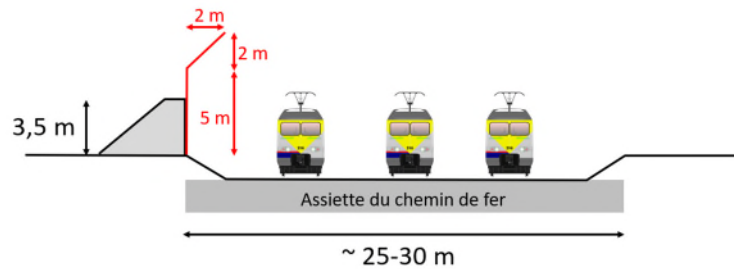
Coupe de principe – Ajout du mur avec casquette (ARIES et Ferrovia, 2021)
